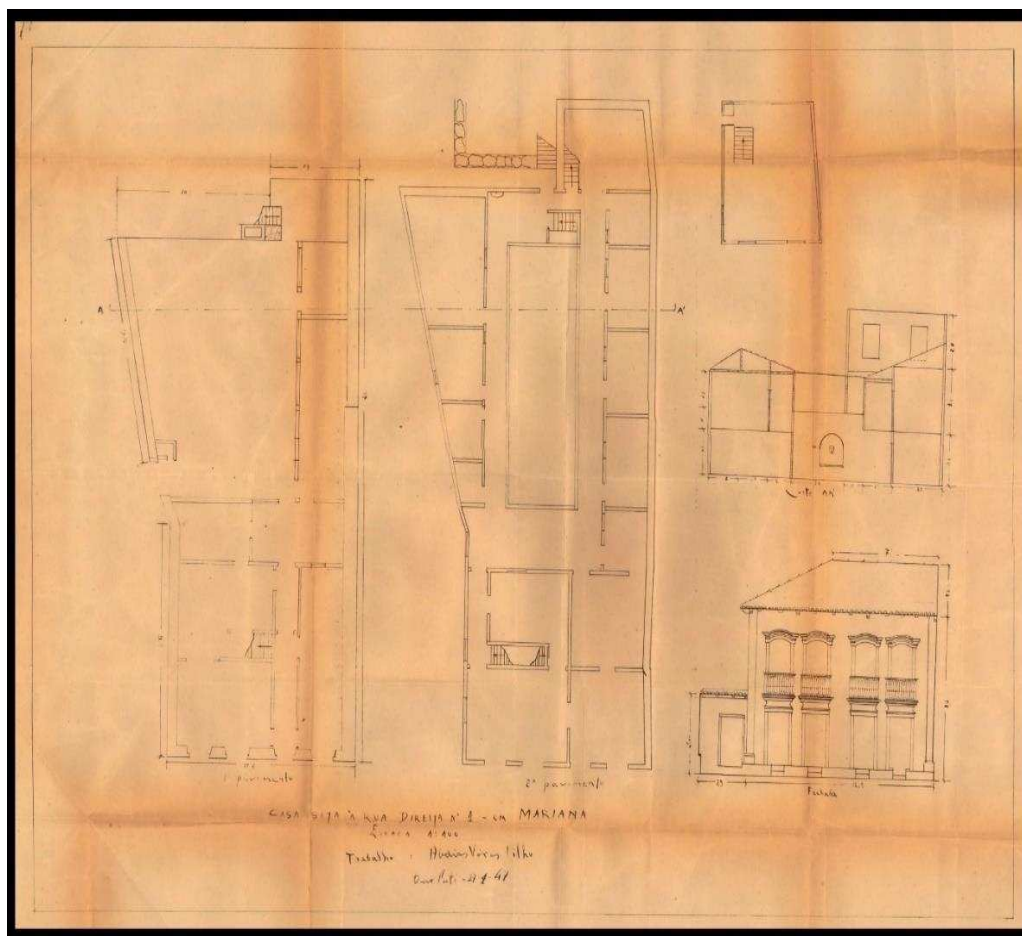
Planta da Casa sita à Rua Direita nº 1 – em Mariana. Escala 1:100. Trabalho Abdias V. Filho. Ouro Preto 27-1-47 Acervo: ACI.
